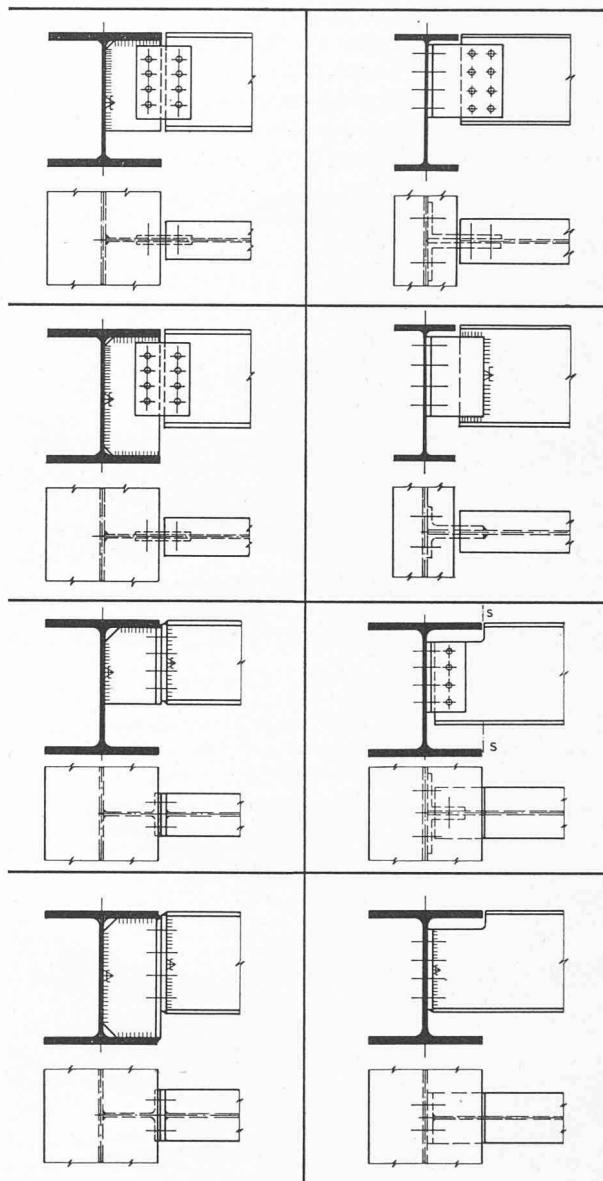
Assemblage de poutres de toiture et de plancher sur des fermes. (Poutres simples, glissées dans les fermes.)
